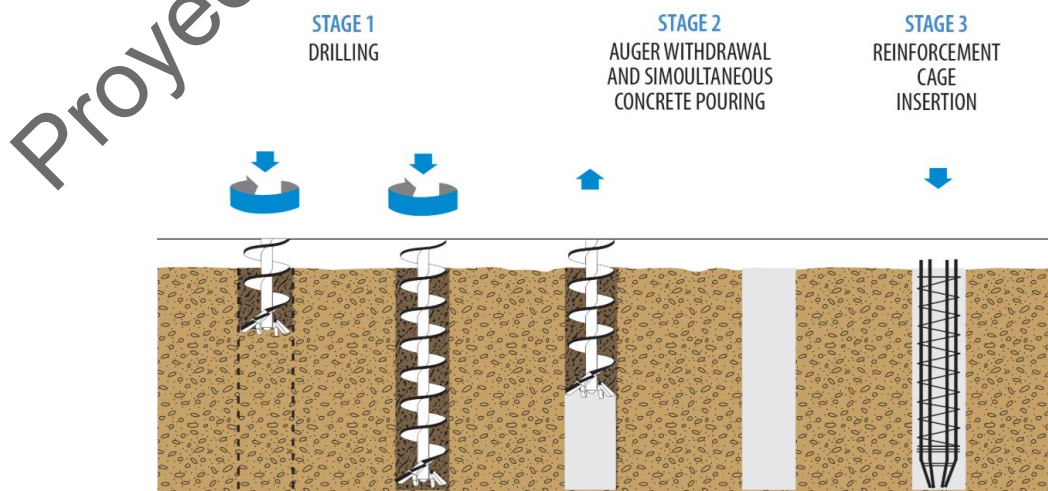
Esquema de pilote de barreno helicoidal continuo.
